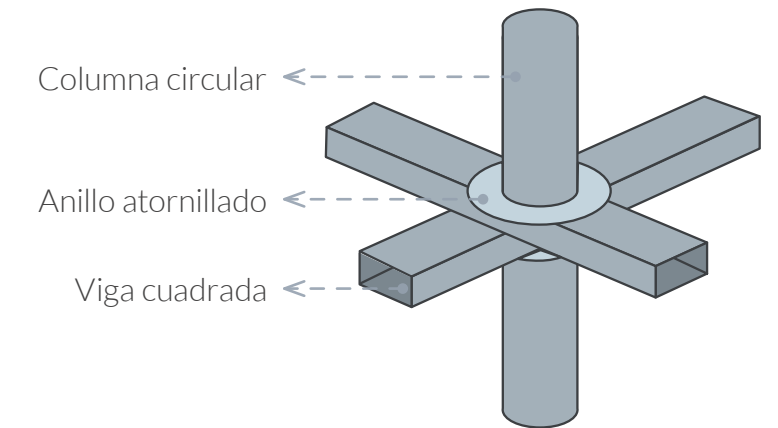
Detalle de junta de viga y columna en Cafetería. Elaboración propia.
